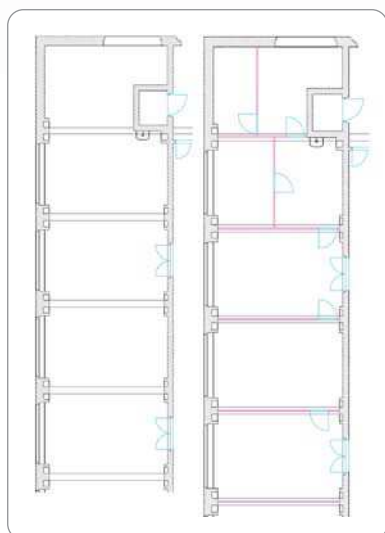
Der Grundriss des Labors. – Abb. 2: Deckenversorgung für Strom, Gas und Luft.
